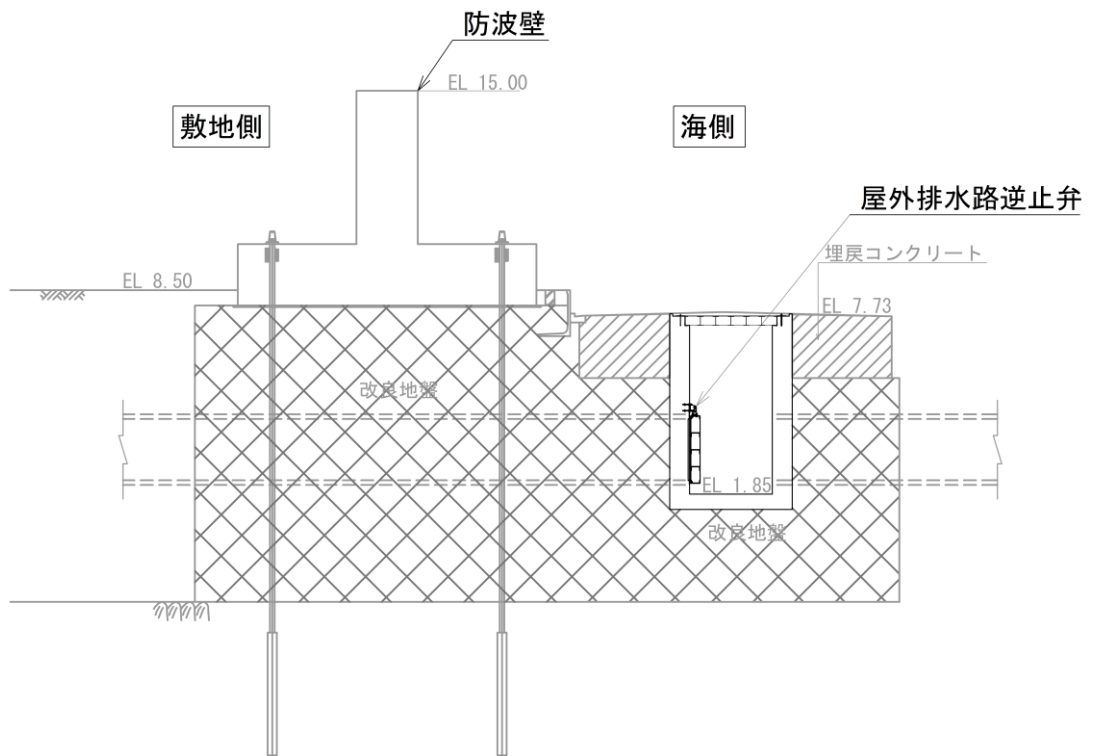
(1) 屋外排水路逆止弁⑨断面図
